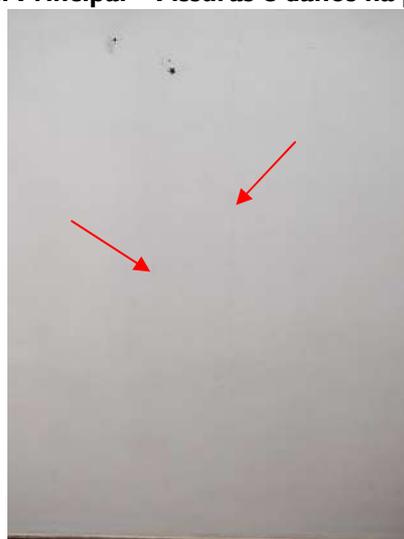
Hall Principal – Fissuras e danos na pintura da parede
